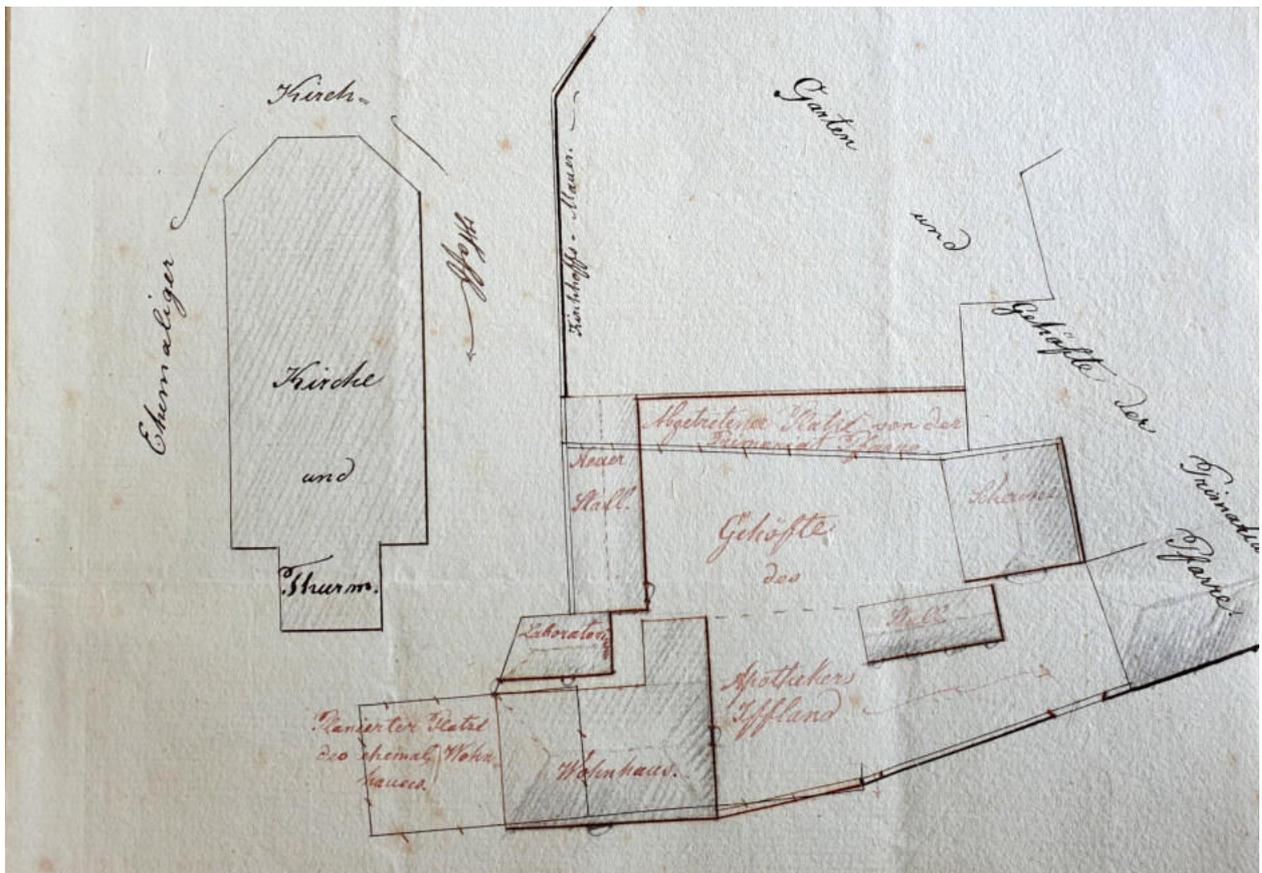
Lageplan zum Wiederaufbau der Apotheke (1826). Der Plan zeigt die Verlegung des Apothekengebäudes nach Süden mit dem Standort des Vorgängerbaus sowie die Nebengebäude auf dem Hofgrundstück, das zur Straße mit einer Mauer abschloss. An der östlichen Grundstücksgrenze ist eine Parzellenerweiterung verzeichnet.
